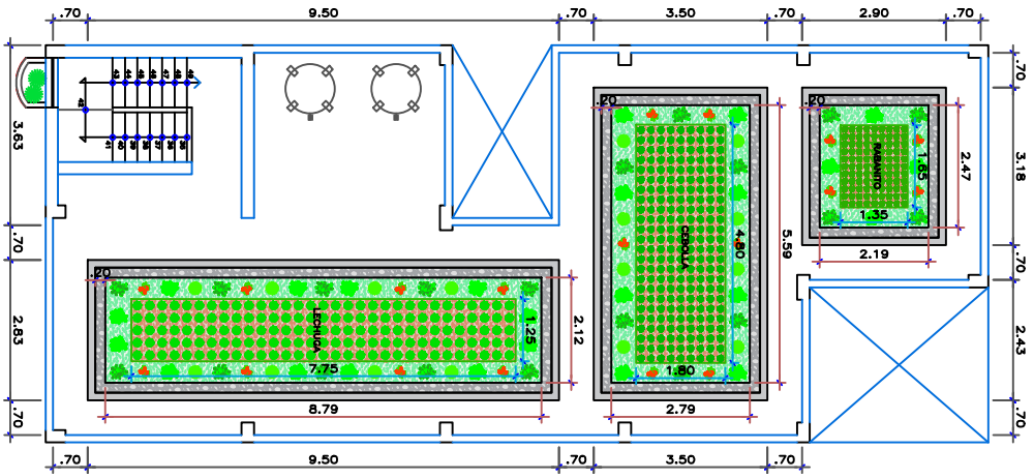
Distribución de áreas del techo extensivo para vivienda propuesta.
